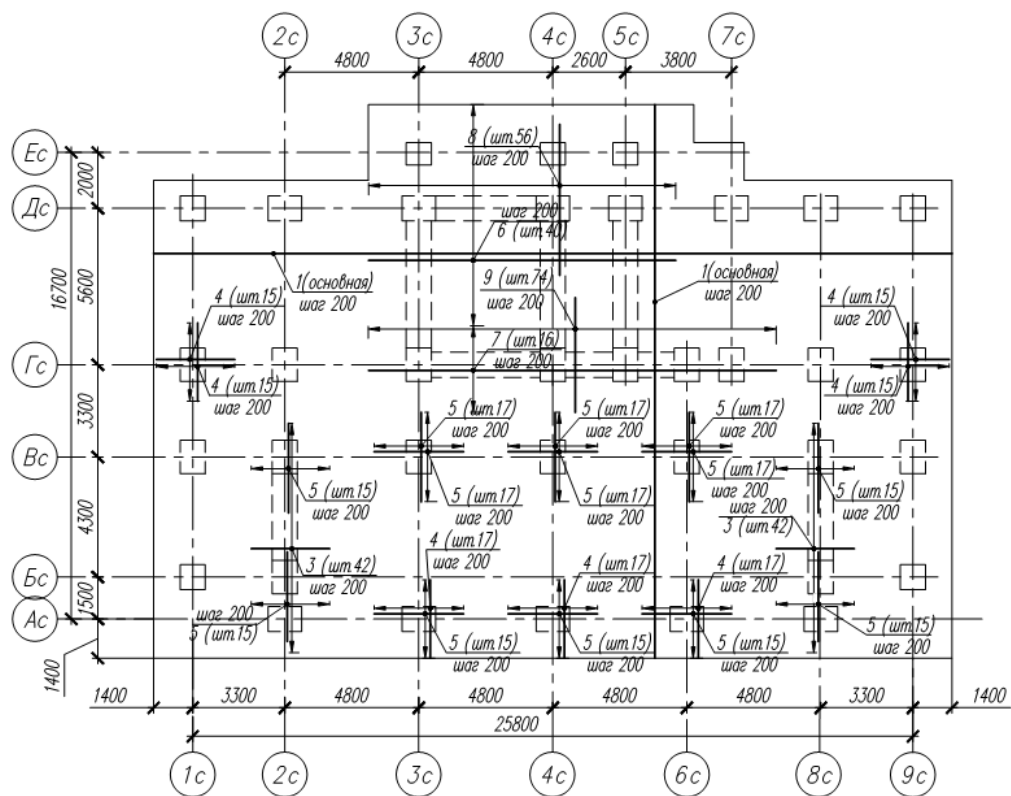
Схема расположения нижней арматуры ж/б фундамента
